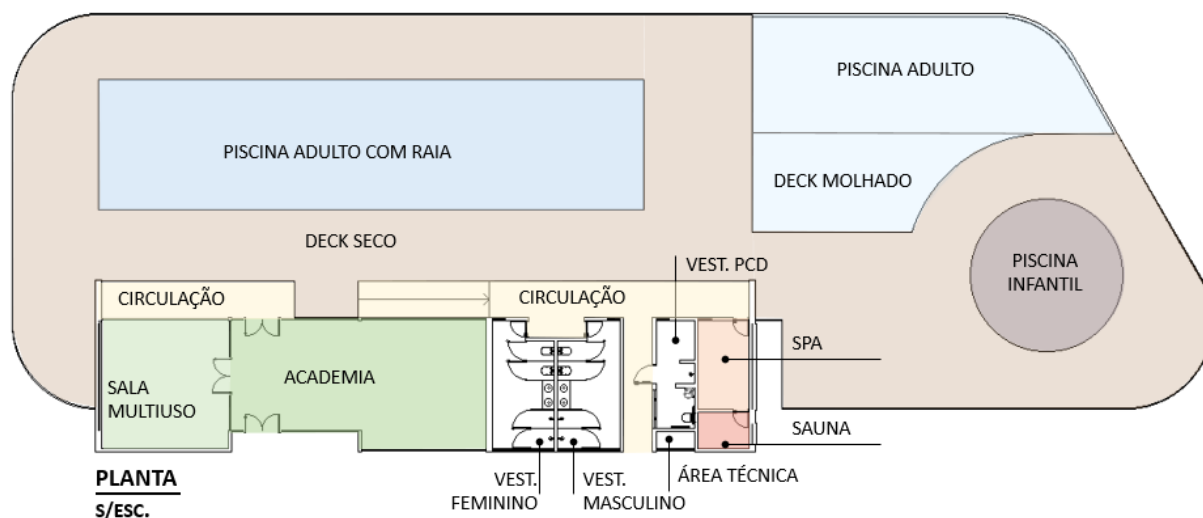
Planta de Arquitetura em fase de Estudo Preliminar
